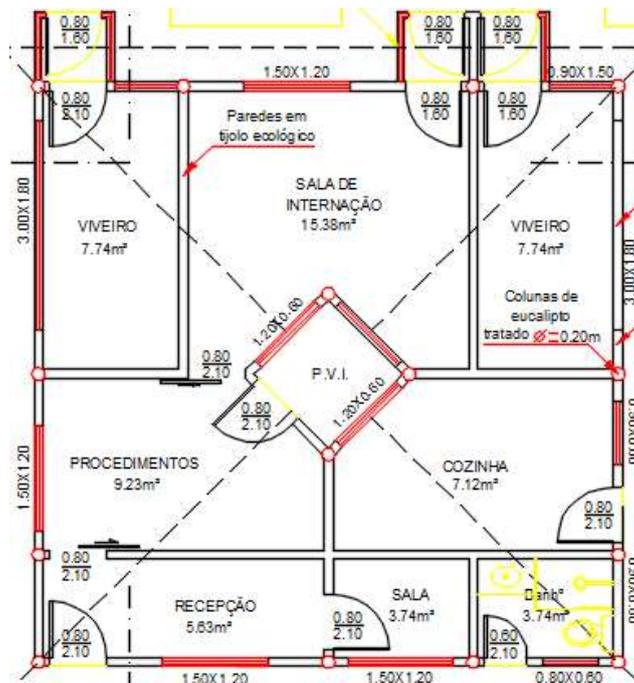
Parte da planta baixa, equipamentos hidráulico-sanitários do viveiro (Departamento de Licitações da Prefeitura de Macaé).
